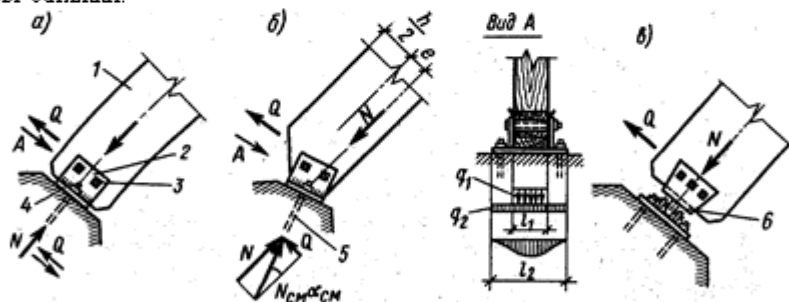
Опорні вузли клеєдерев'яних арок без затяжок
